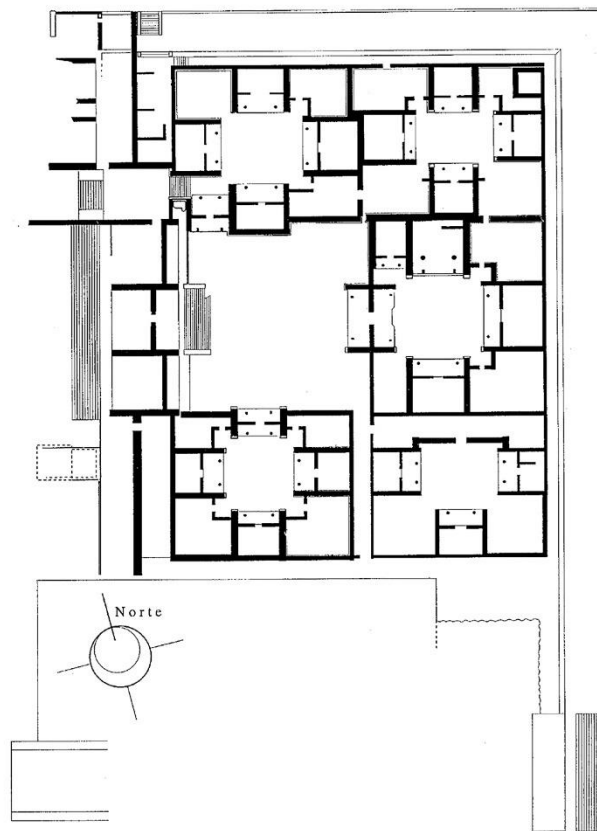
Planta del conjunto 1D de La Ciudadela (Manzanilla et al. 2005:198).
